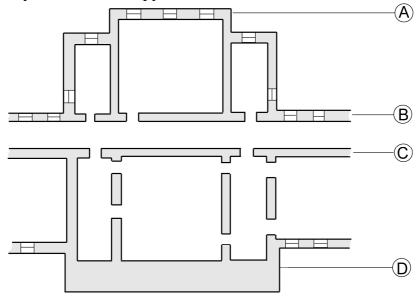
Эскиз площади сбора нагрузок для главного корпуса НГУ
